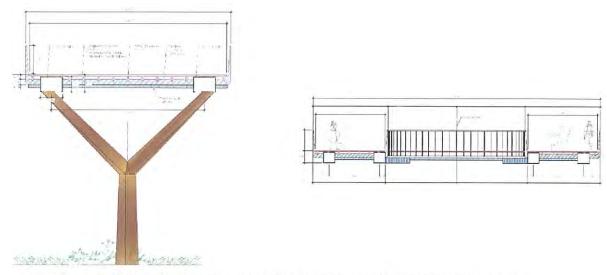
Sección transversal sección continua y de abertura alternativa 6.
